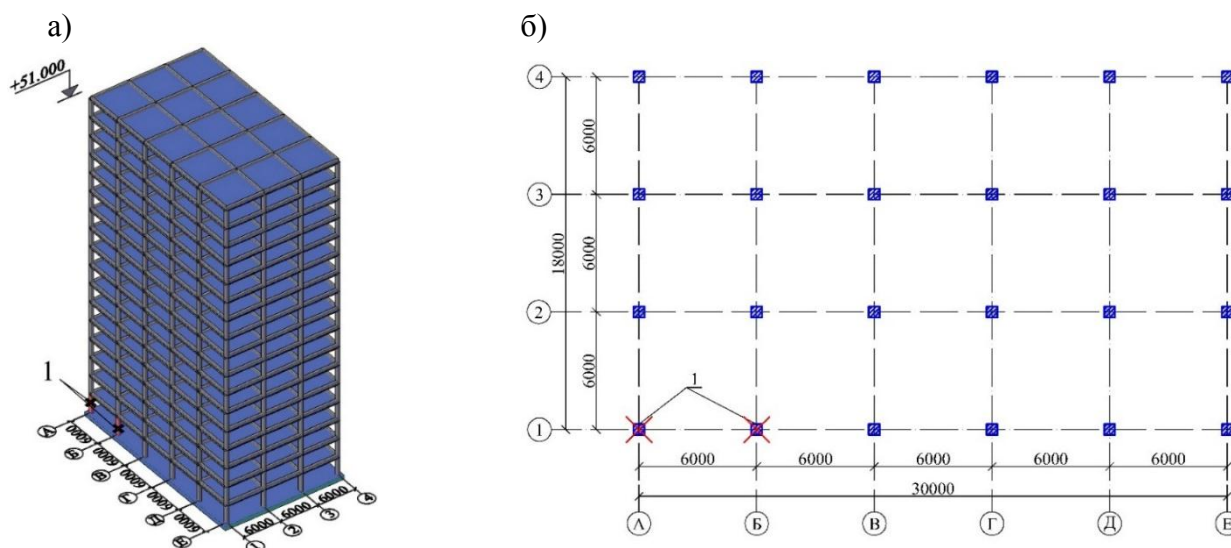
Конструктивная схема (а) и план типового этажа (б) железобетонного каркаса здания:
